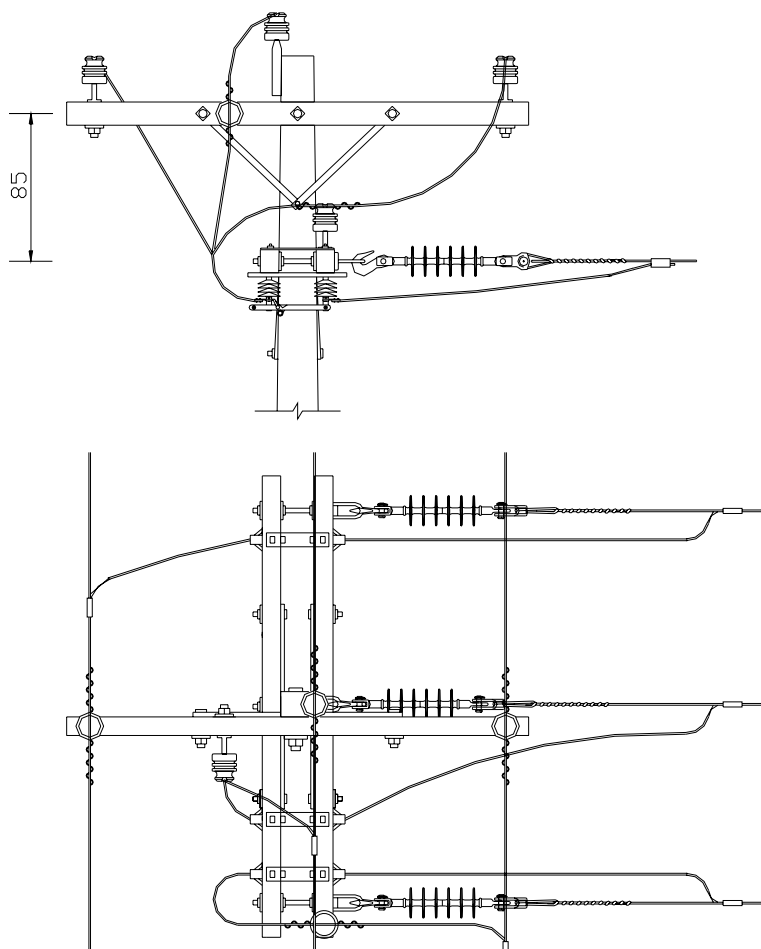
Estrutura T1-N3 (derivação chave faca)
